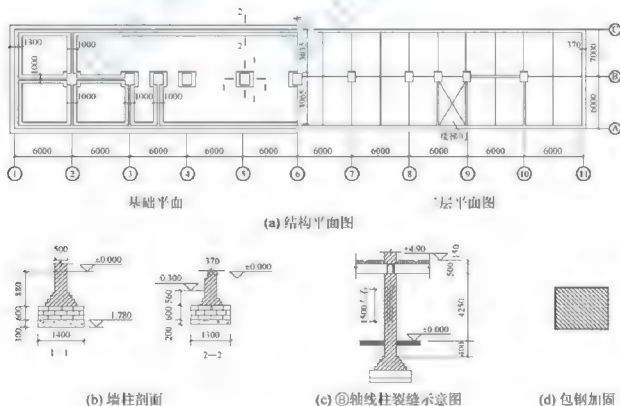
某轻工业厂房平面及砖柱裂缝示意
